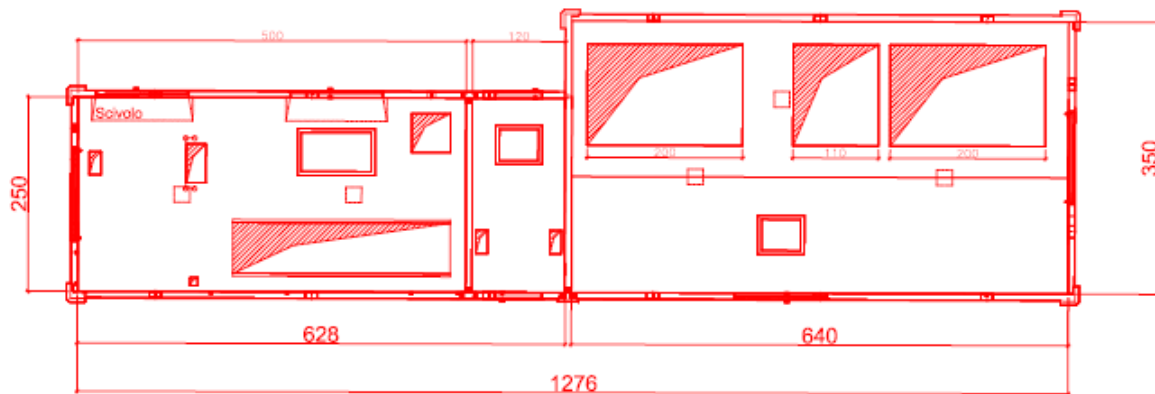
Pianta piano terra del fabbricato FAVR nel Progetto di variante.
